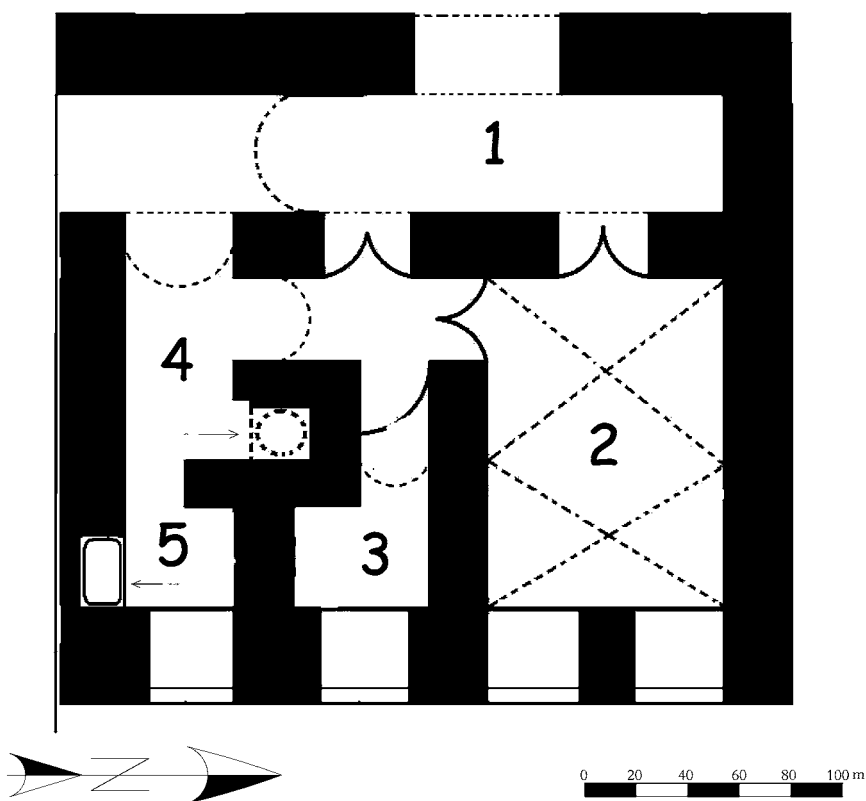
قصر علي باشا بن عون : مسقط أفقي للطابق الأول. (عمل بمعرفة الباحث).
